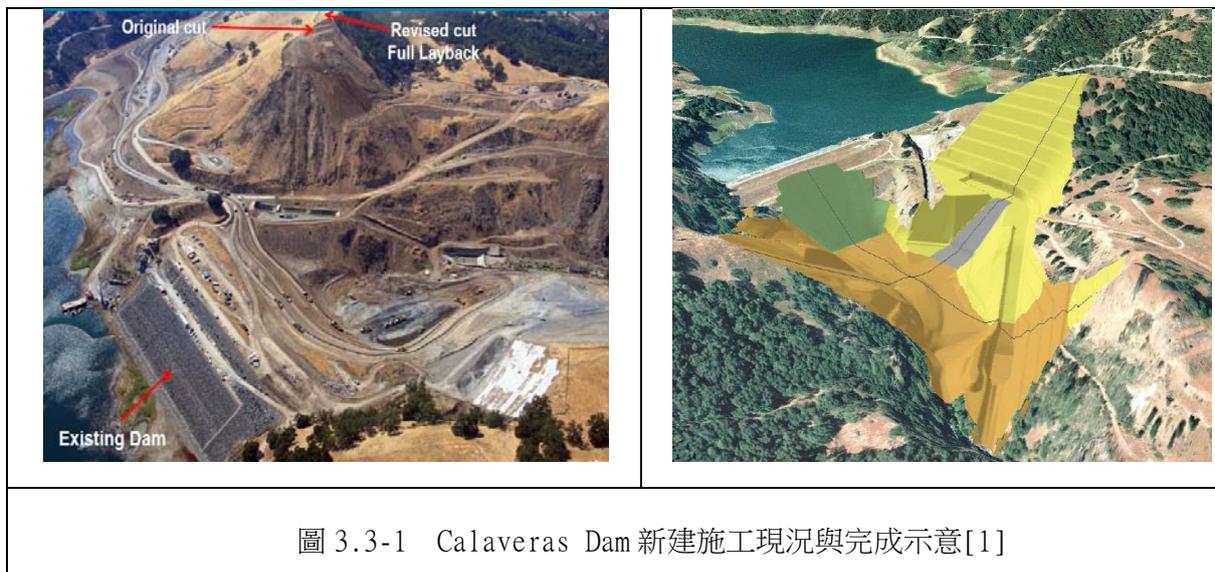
Calaveras Dam 新建施工現況與完成示意[1]
